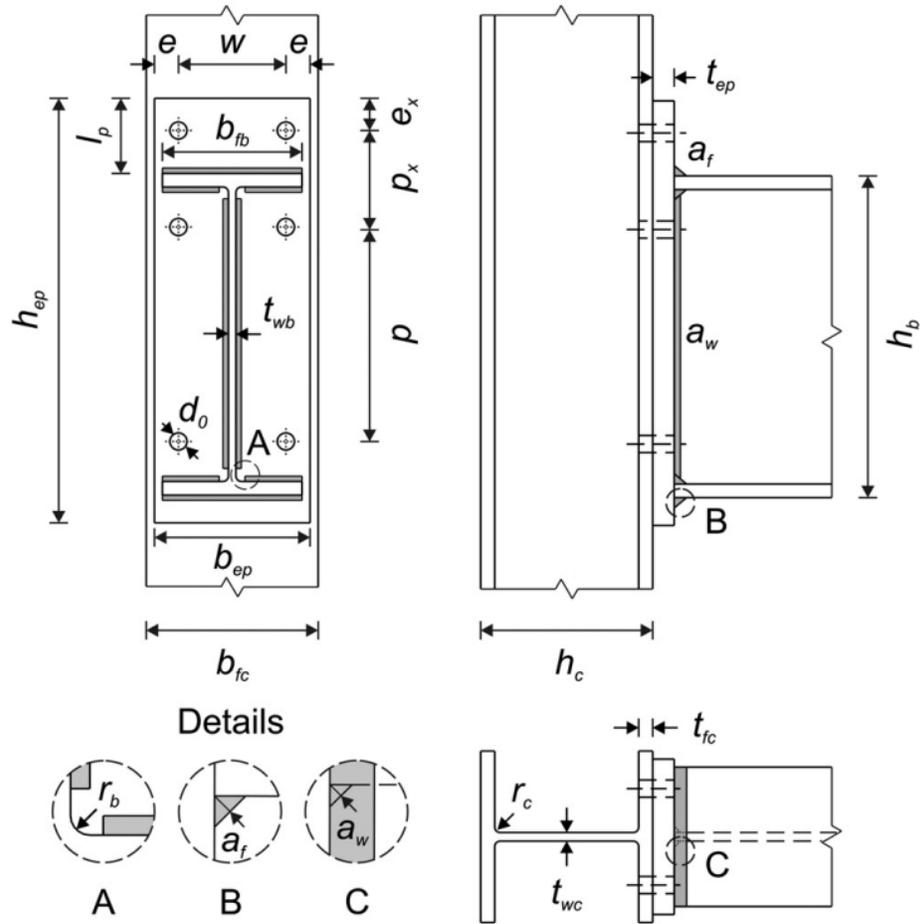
Miembros y elementos de la conexión viga-columna empernada con platina de extremo ampliada
